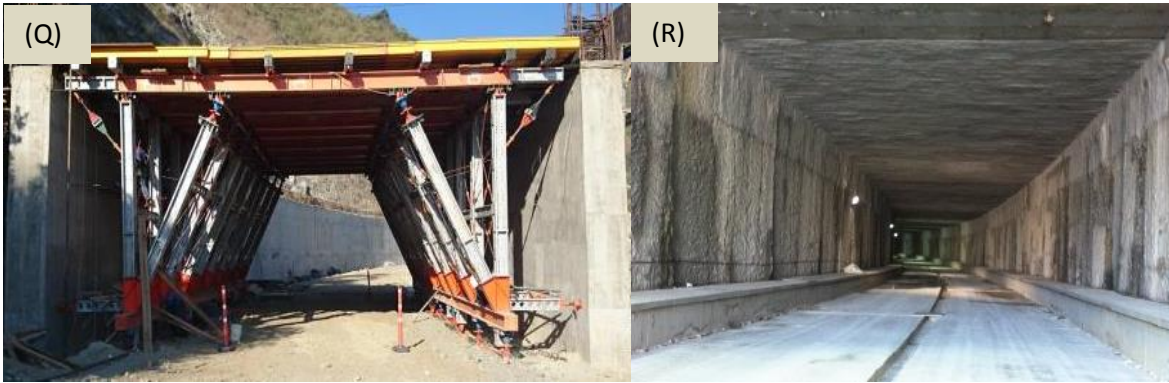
(Q) “Cut and Cover” para la construcción de desniveles carreteros con muro Milán, (R) “Cut and Cover” para la construcción de túneles carreteros urbanos de sección rectangular.
